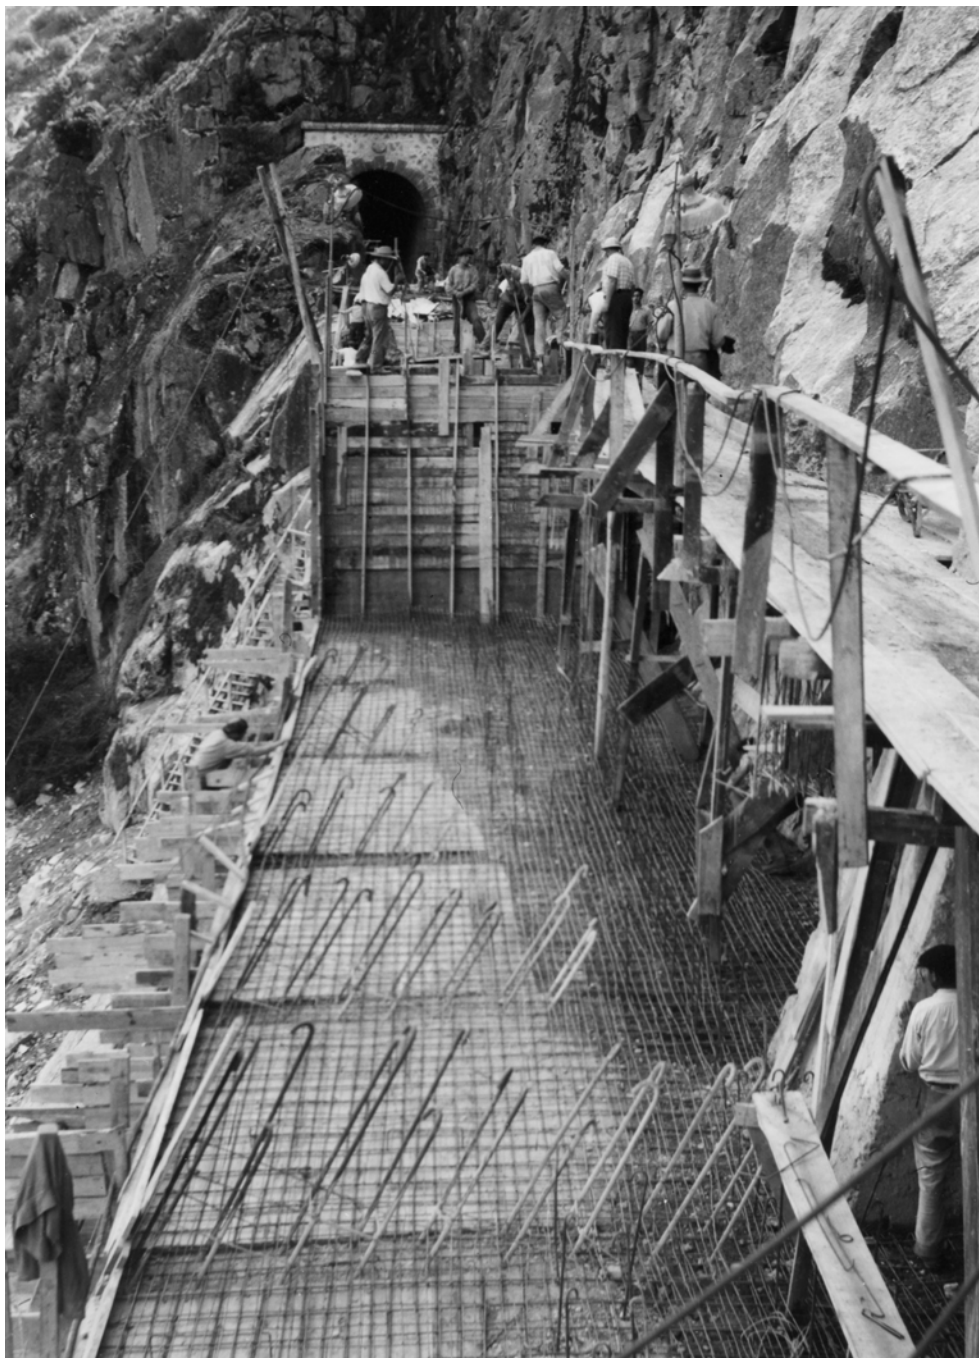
Viaduto das Fragas Más – betonagem do pilar central – cofragem e armaduras da laje de travessão e apoio da estrutura celular no tramo do lado da Foz do Tua (fonte: REFER)
